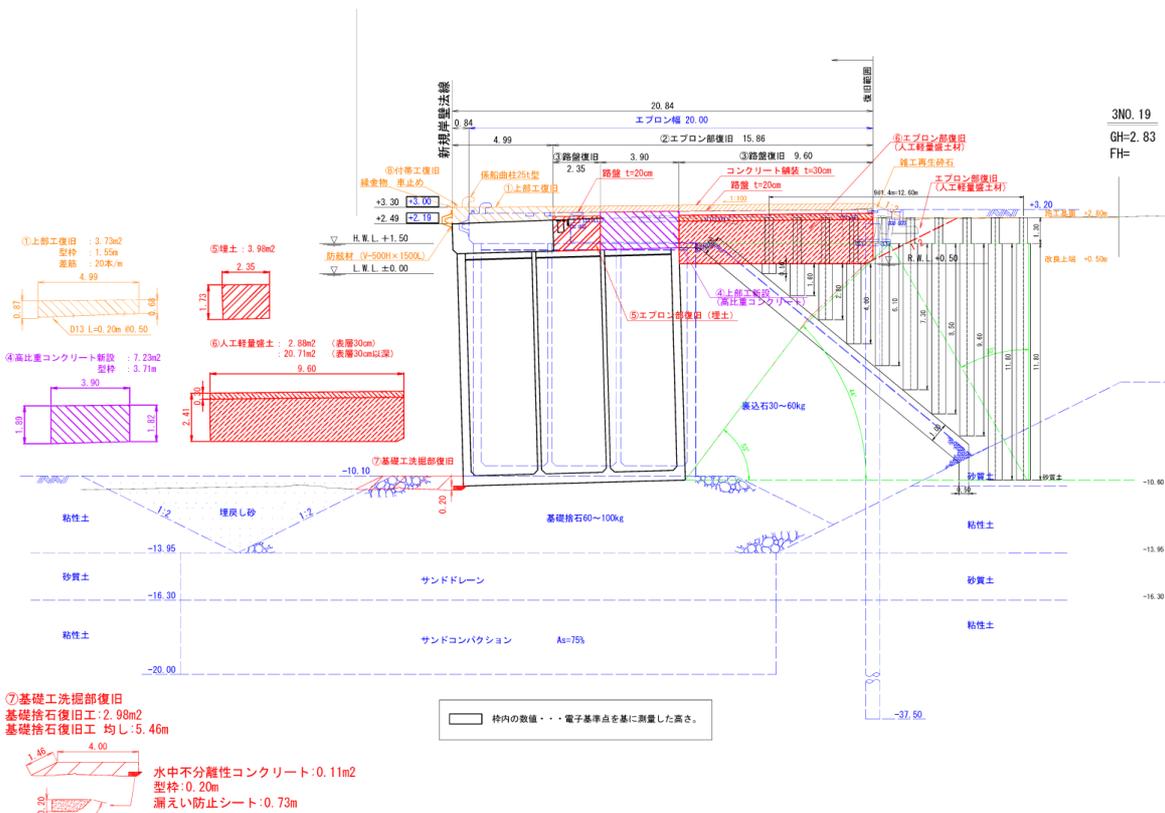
No.10 日立港区_第4ふ頭地区 4-D岸壁 (-10.0m) の断面図 No.3 (復旧後)
